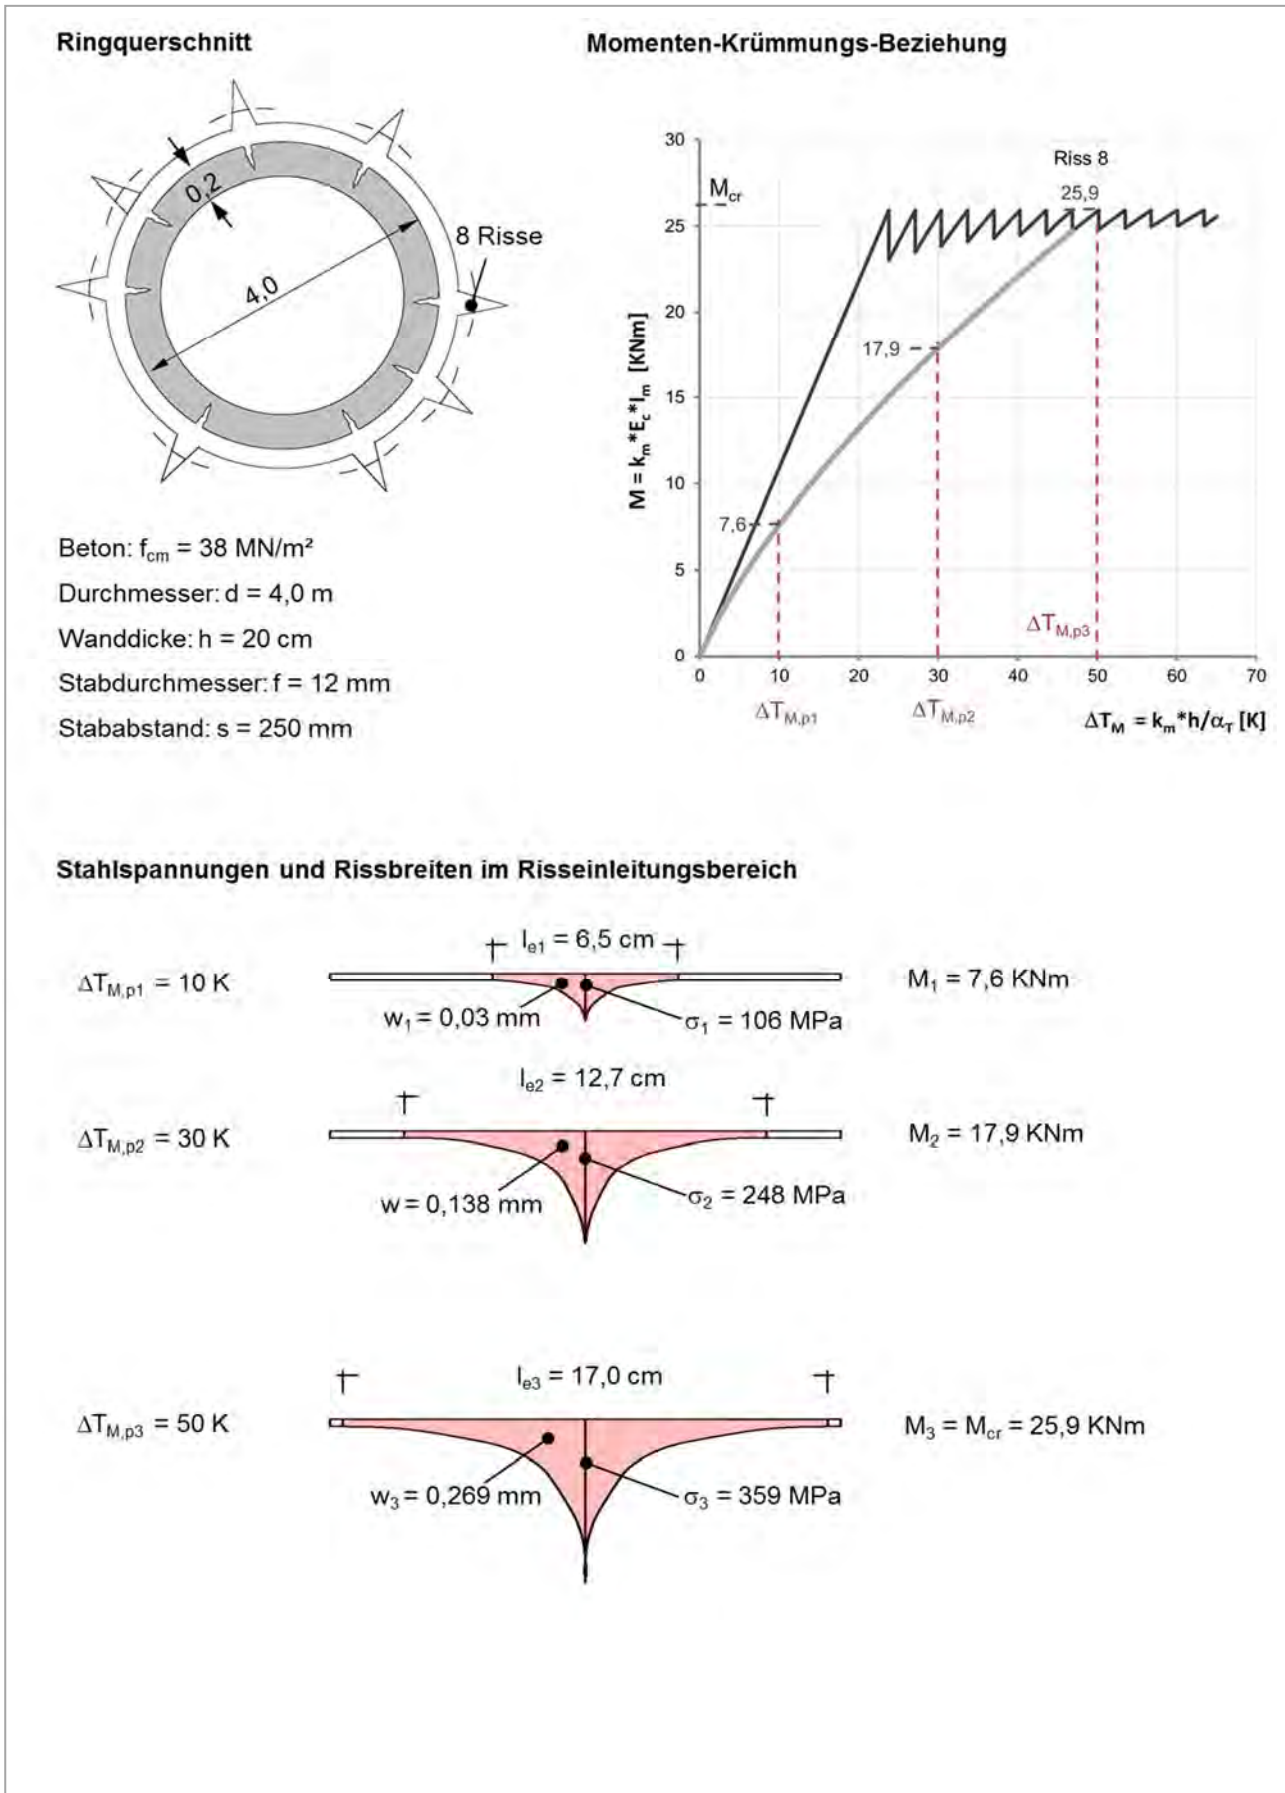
M-K-Beziehung, Stahlspannung, Risseinleitungslänge und Rissbreite für den Turmquerschnitt
